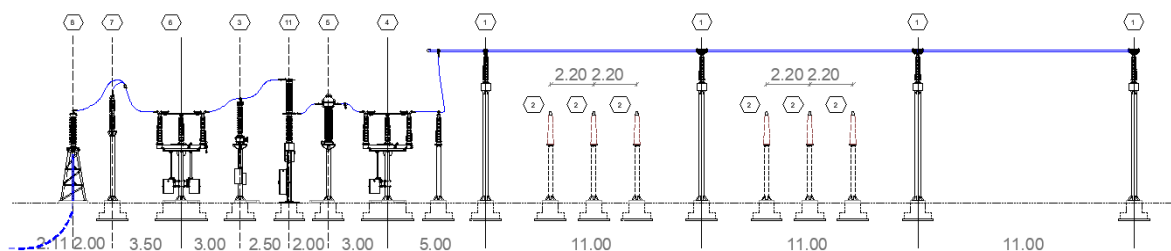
Sezione Longitudinale elettromeccanica stallo AT 150kV (SE Utente)
